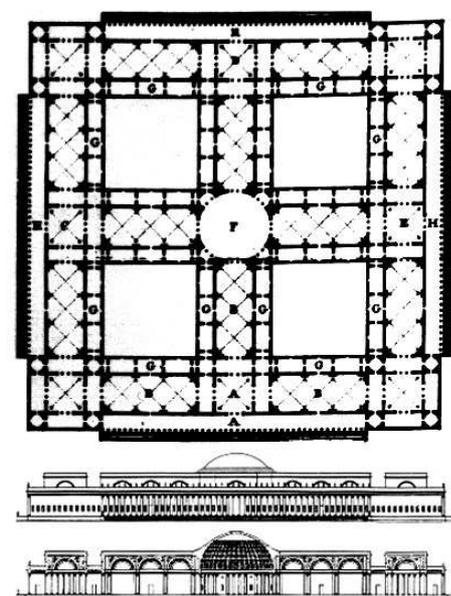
Projeto para museu, Jean Nicolas Louis Durand, *Précis*, 1802-1805. Planta baixa, elevação, corte.
